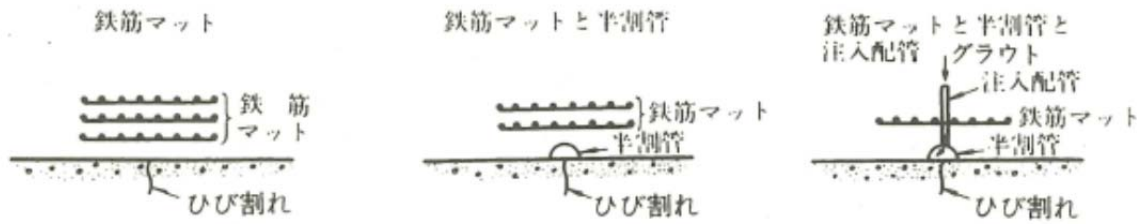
水平打継目に発生したひび割れの処置例¹⁾
